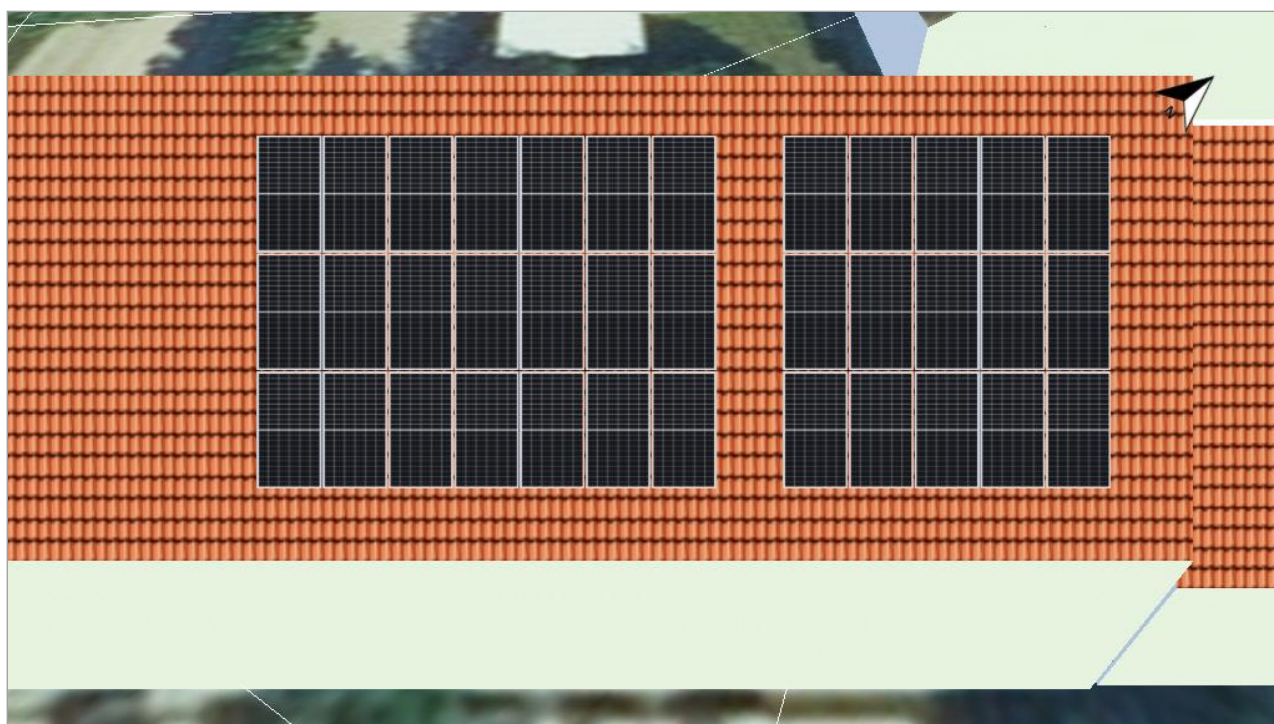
Plocha modulu - Building 08-Roof Area Southeast
